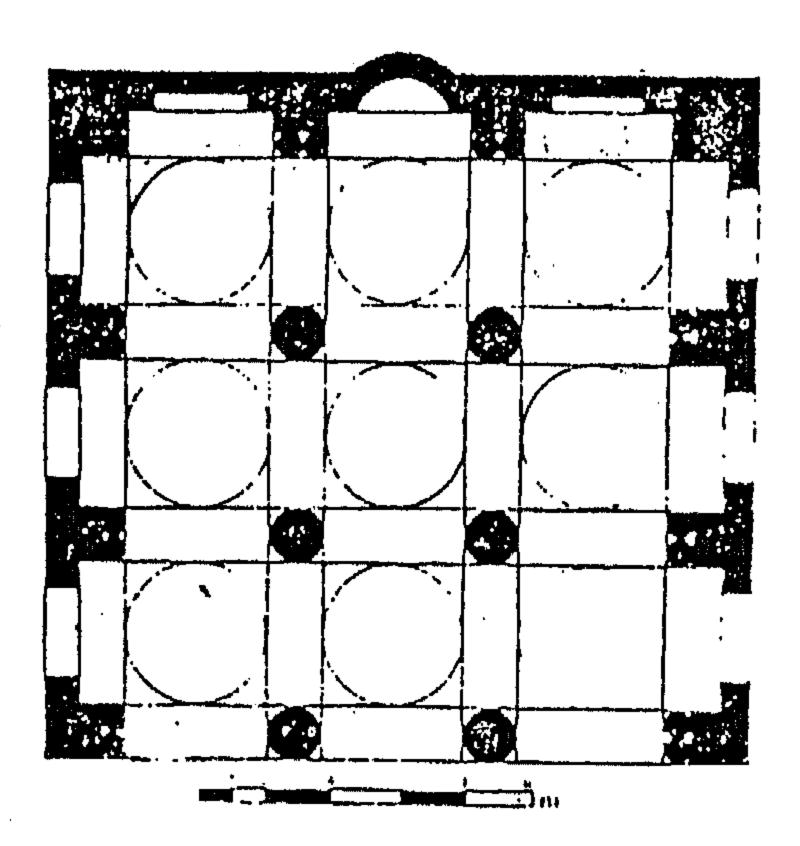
مسقط أفقي لمسجد حاجى أوزبك بازنيق التركية (٢٣٤هـ/١٣٣٢م) . (شكل ٤) عن : Goodwin) .
